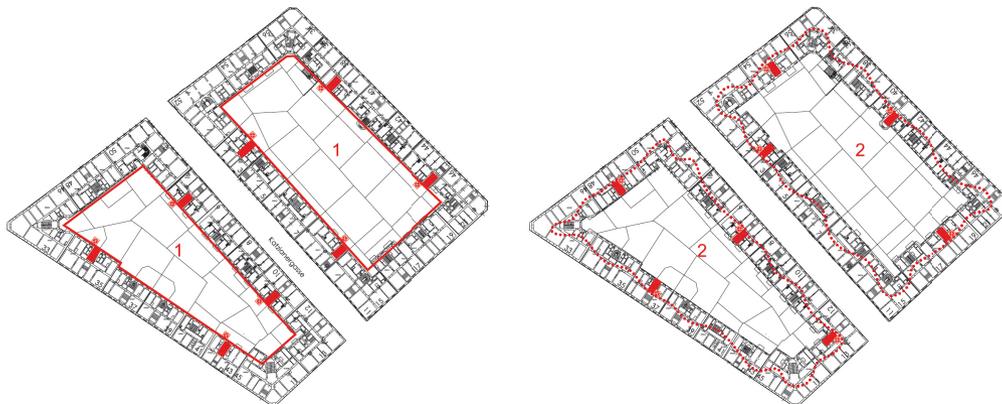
Nachträgliche Erschließungsvarianten für parzellenübergreifenden Dachaufbau, Institut für Gebäudelehre, TU Graz
